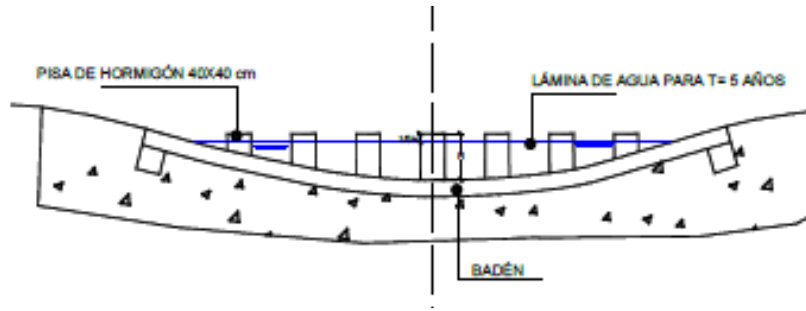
Sección transversal de badén con pisas laterales para el cruce peatonal. Fuente: Elaboración propia.
